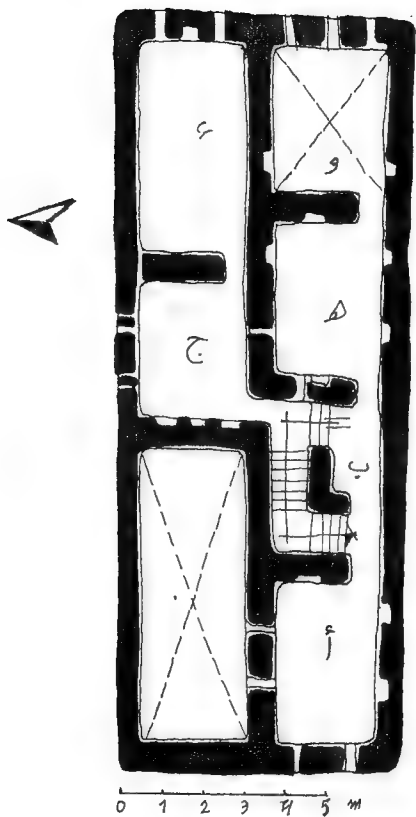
منزل الشريف أحمد الدور الثاني مسقط أفقي "نقلا عن علي لبيب محمد" مرجع سابق
